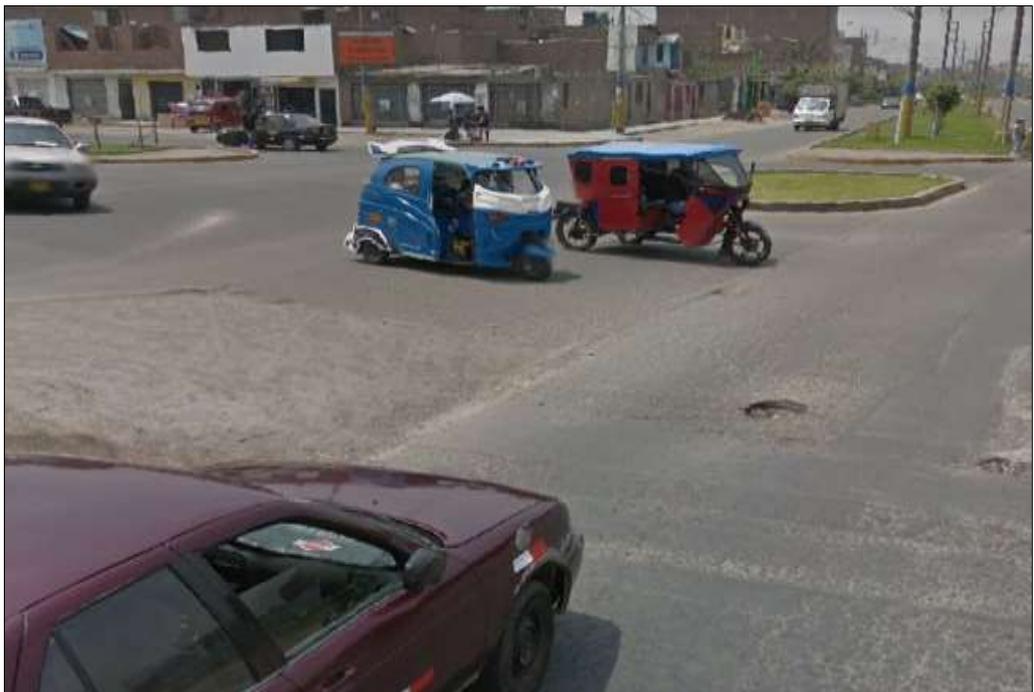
Pavimento de la Av. República de Polonia – San Juan de Lurigancho
